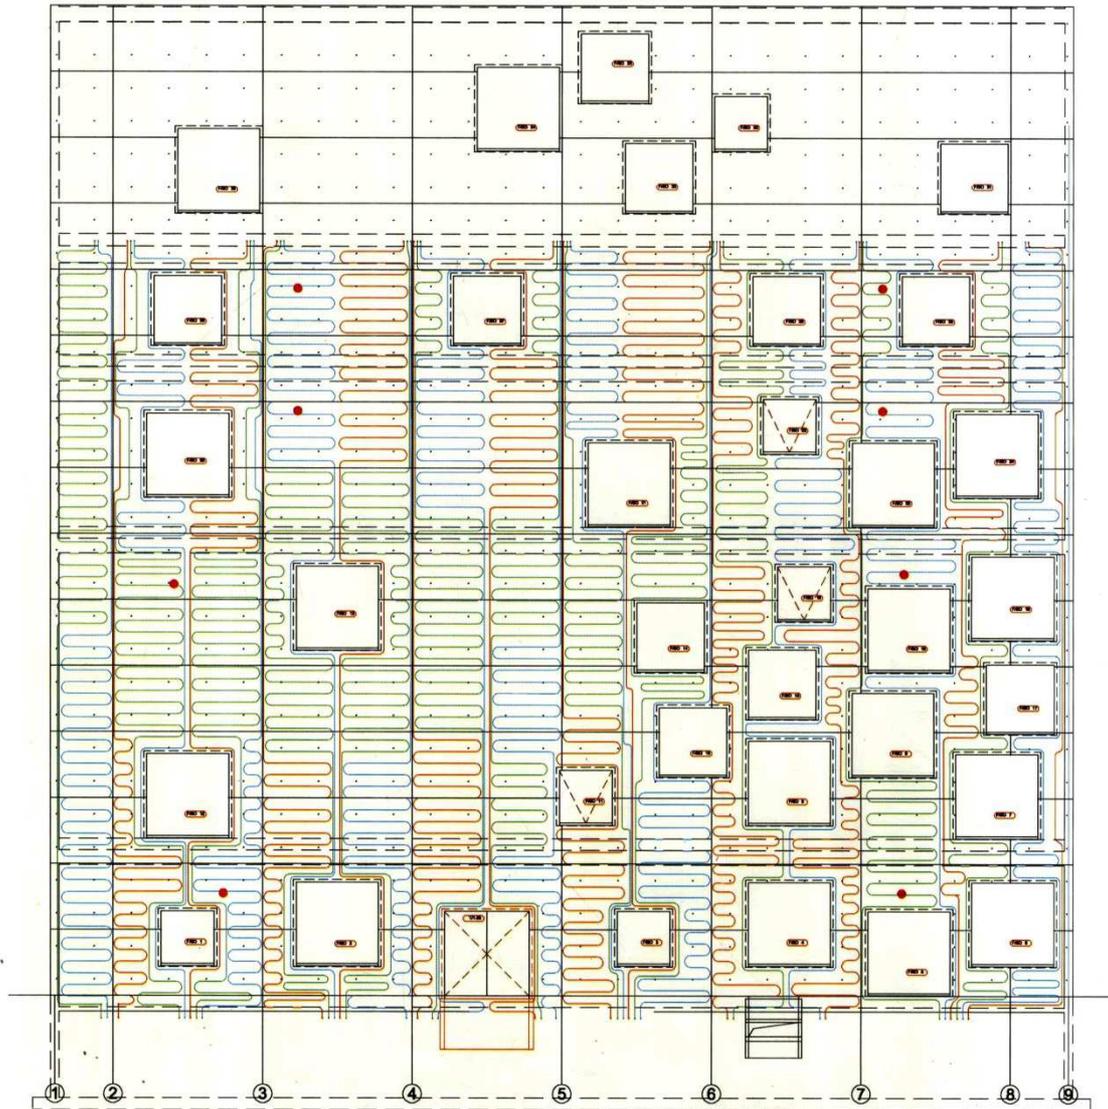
Distribución del sistema de aislamiento activo en una de las fachadas
